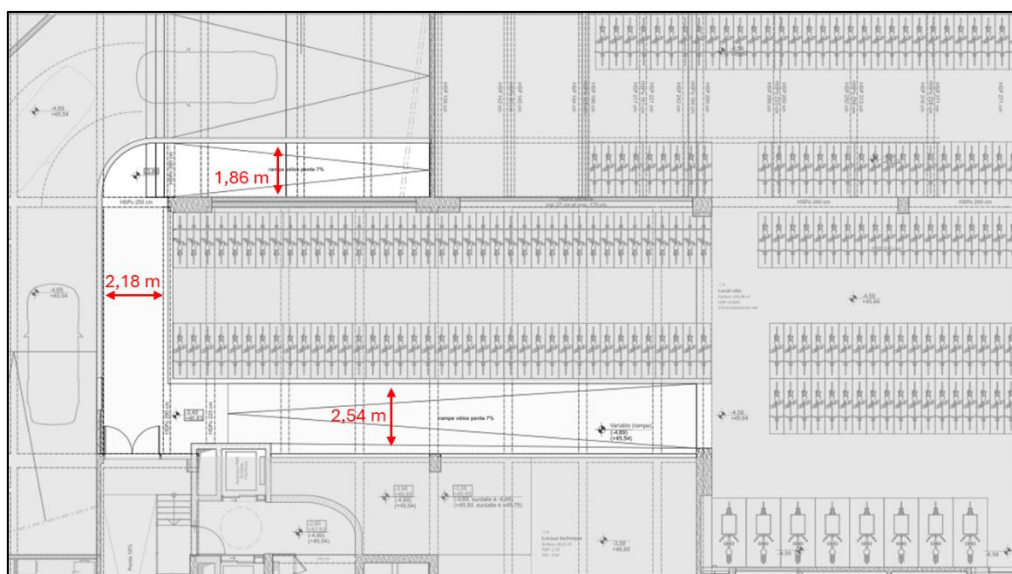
Largeur de la rampe d'accès au parking vélo (Source : POLO et Baumans-Deffet)
